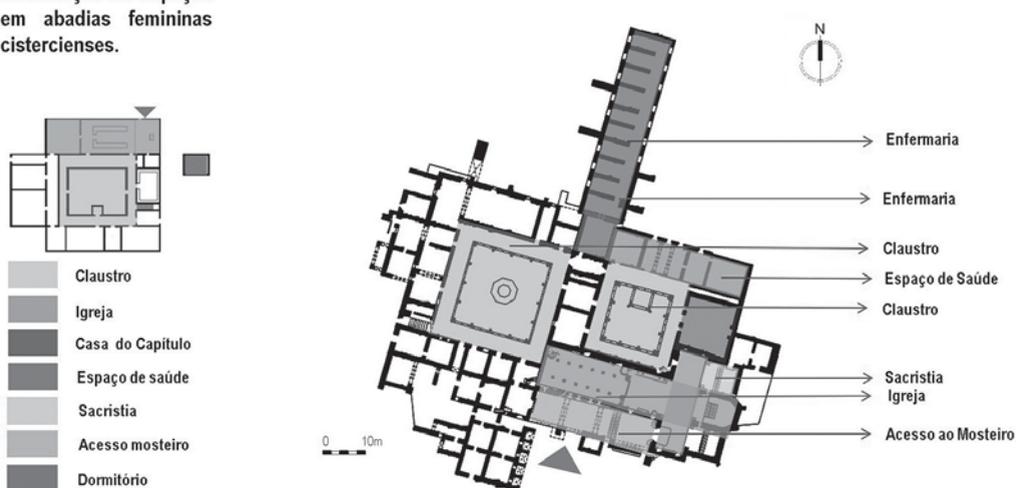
Planta do piso térreo do mosteiro. Fonte: planta desenhada por M. C. Tereno com base em Ana Tavares Martins.
